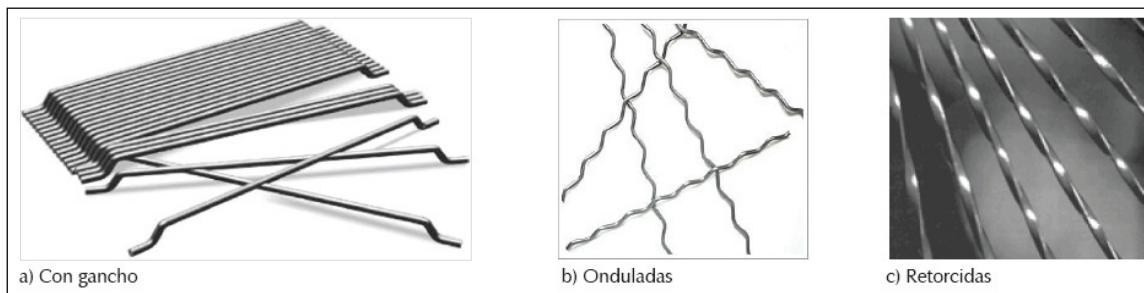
Principales fibras de acero utilizadas para el concreto lanzado. [3] Alcocer (2012).
